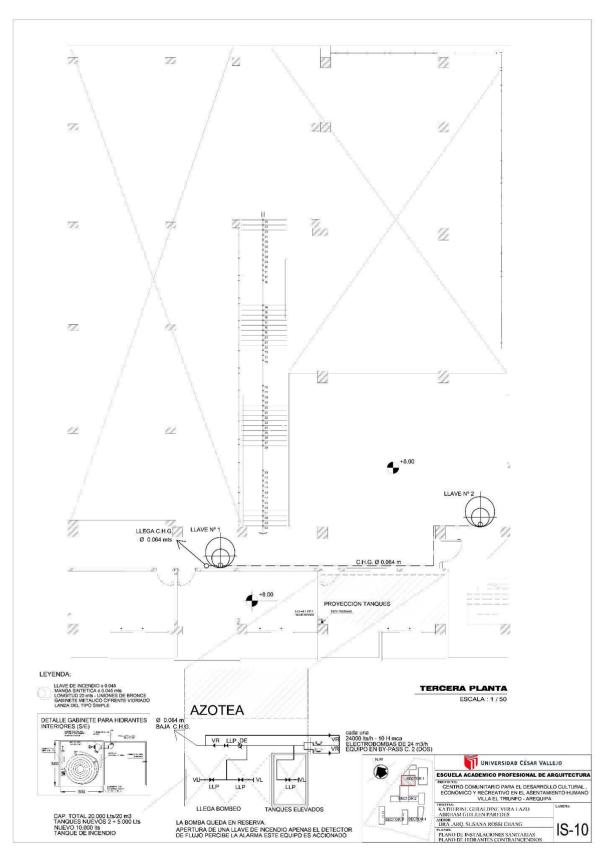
Planos de distribución de redes de agua potable (hidrantes) Tercera Planta - Elaboración propia
